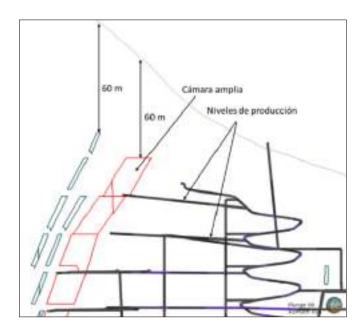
Sección transversal mostrando el detalle del pilar de corona de la mina
